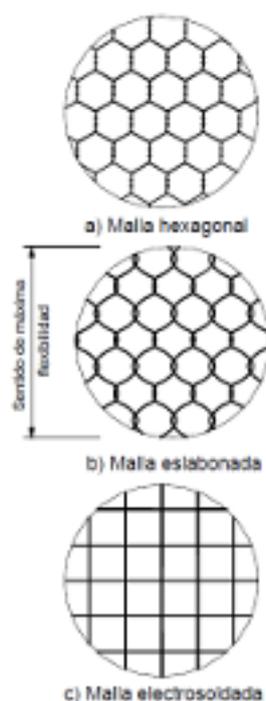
Tipos de mallas utilizadas en la construcción de gaviones. Fuente: (Suárez Díaz, 2001).
